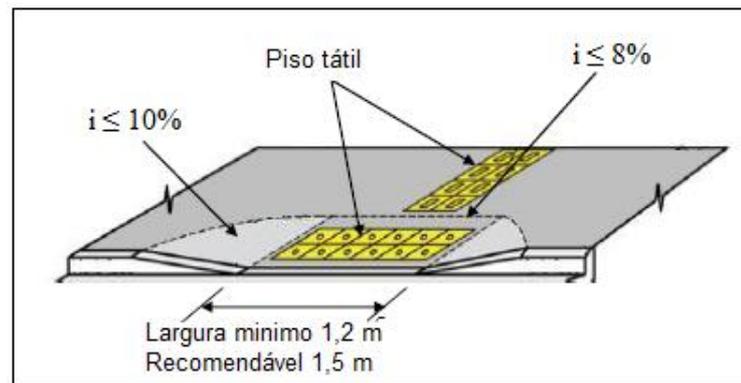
Dimensões recomendadas para o projeto de rampa de acesso a travessia [adaptada da Fonte:(LNTZ, 2009)]
